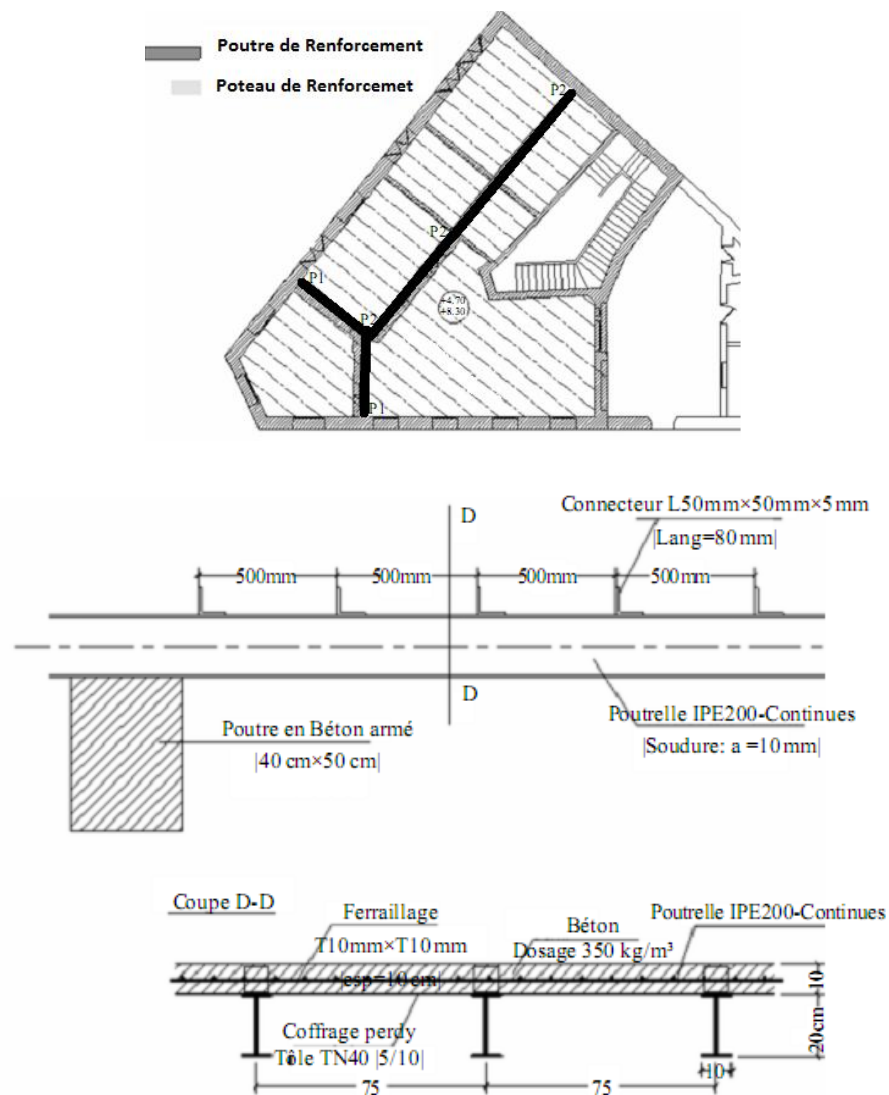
Vues du système de renforcement de la structure (portique interne)
